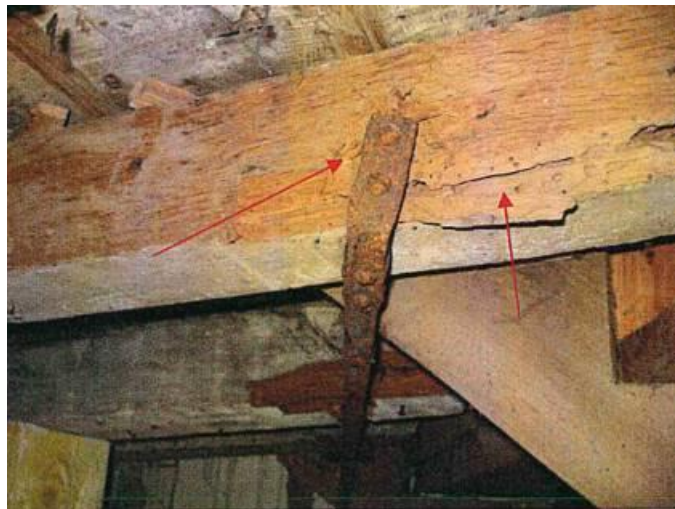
Solives reposant poutres 1 à 2 – Dégradation de la solive n°3 – Corrosion du plat métallique – Extrait rapport Apave
